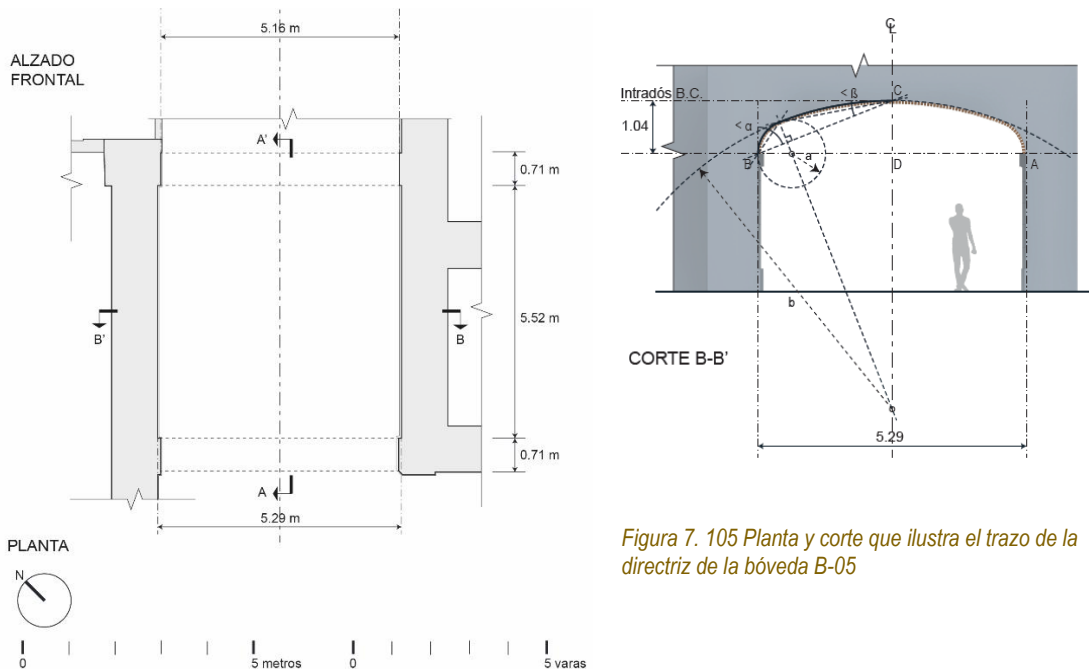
105 Planta y corte que ilustra el trazo de la directriz de la bóveda B-05
